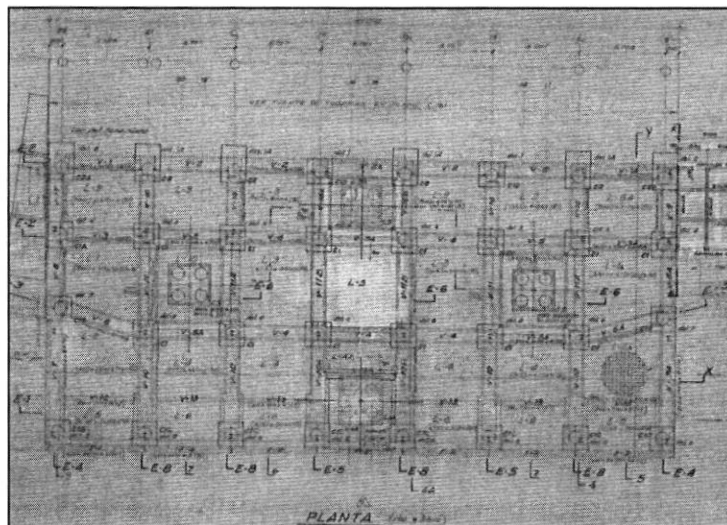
Disposición en planta de capiteles, vigas y losas en la plataforma
